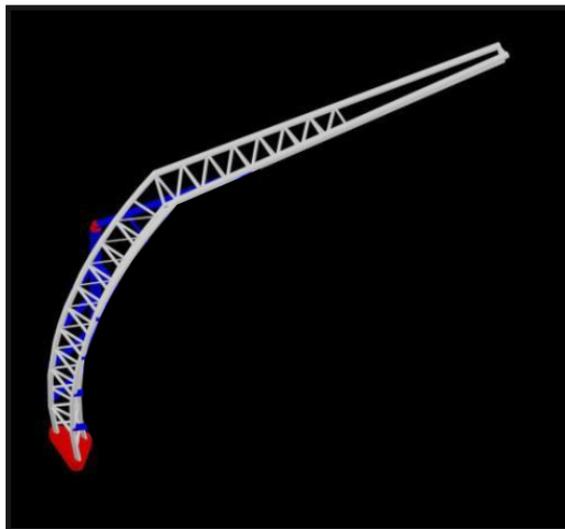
Photo qui montre des poteaux curvilignes installés tout au long de la périphérie d'un projet afin d'épouser la forme du projet
